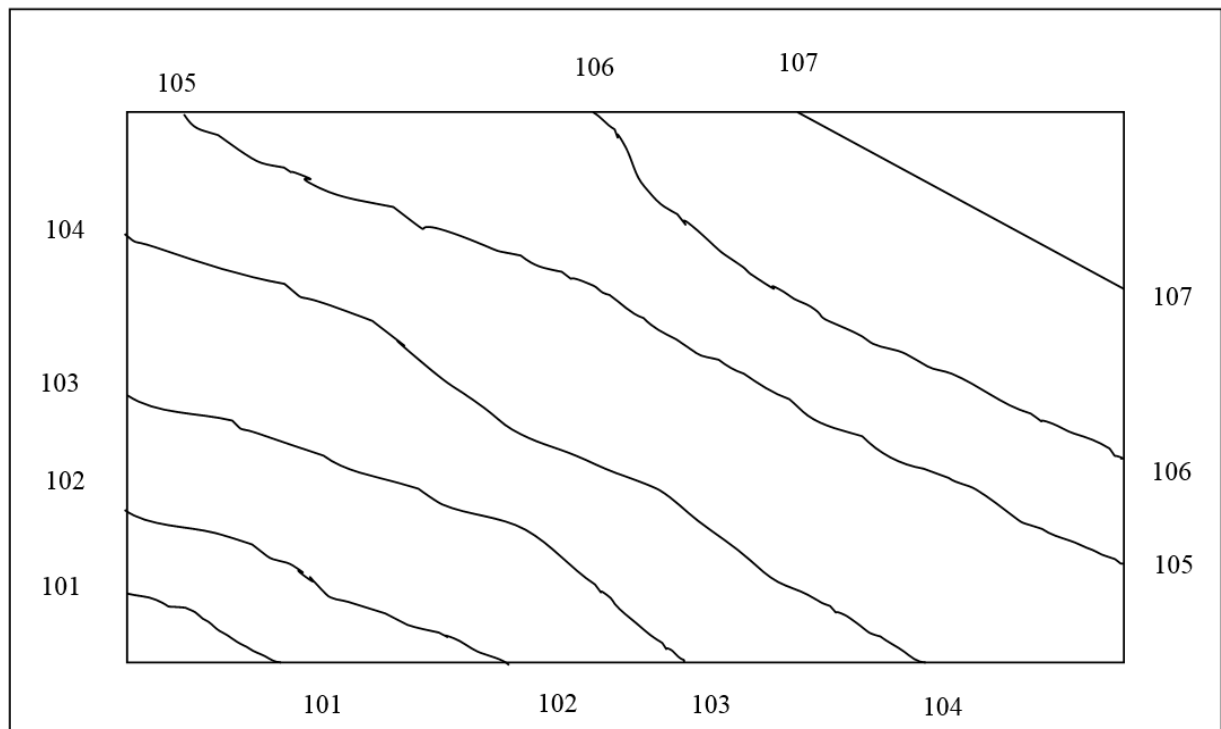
Топографический план строительной площадки размещения полигона ТКО
